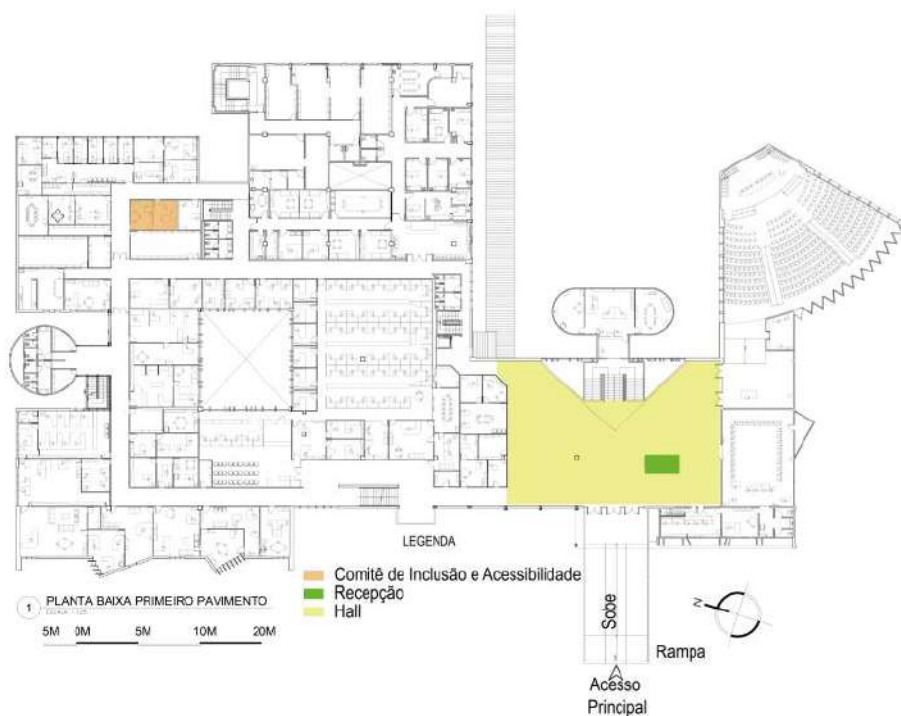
Planta baixa do primeiro pavimento com destaque para Hall, Recepção e Comitê de Inclusão e Acessibilidade -
